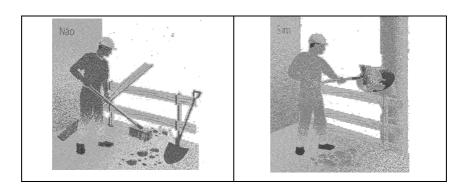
Retirada de entulhos em elementos plásticos no pavimento
